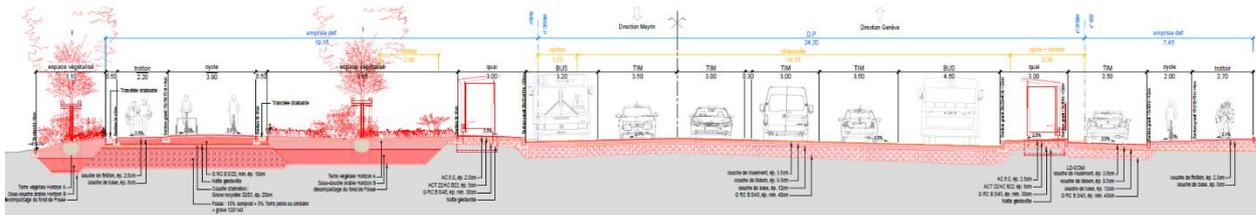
Coupe sur la route de Vernier cantonale au droit de l'arrêt Bois-des-Frères
